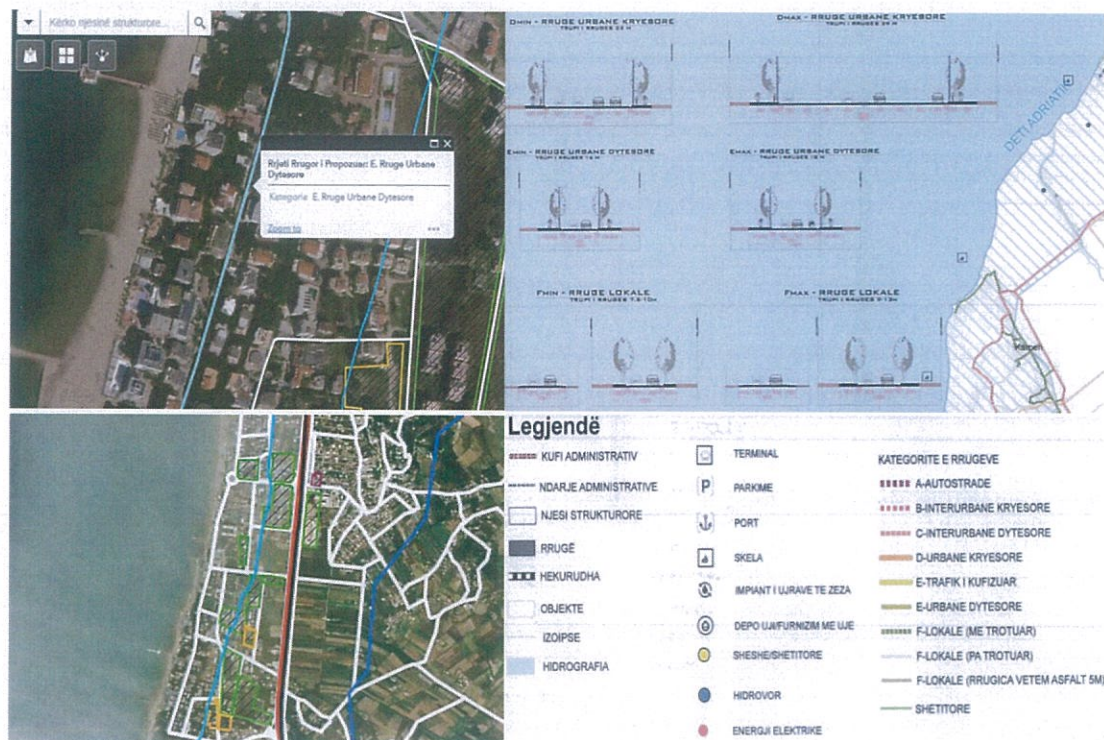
Rruga e aksesit dhe tipologjia e saj brenda zonës së propozuar për zhvillim.
